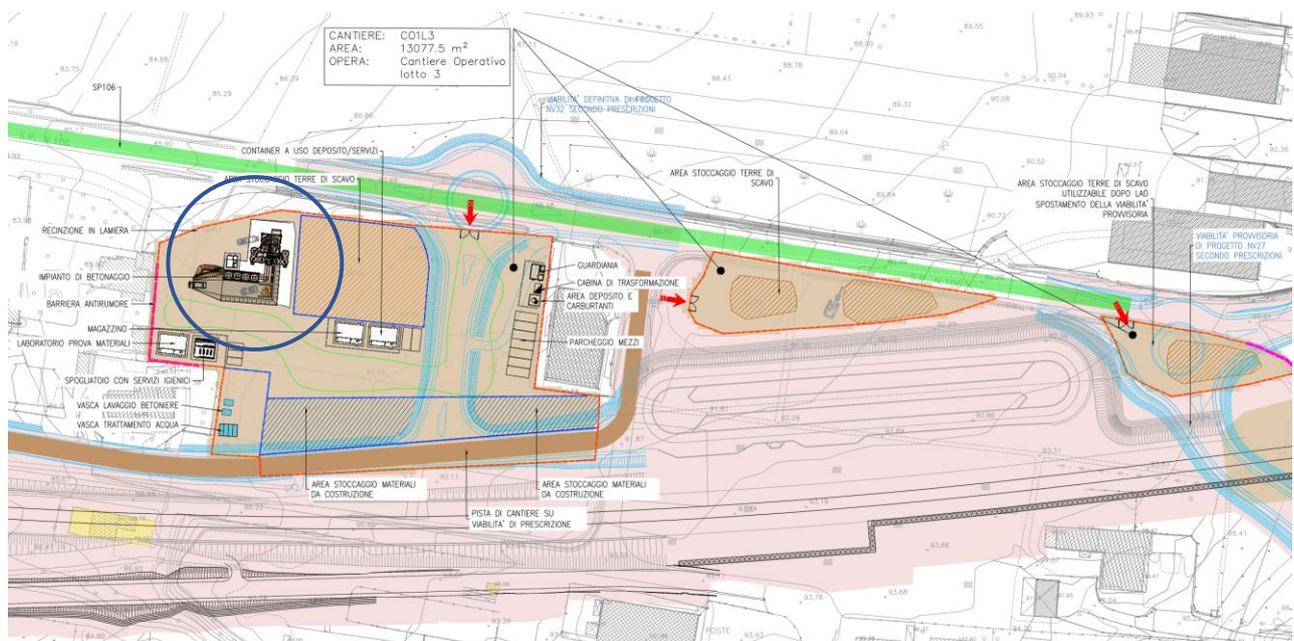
Planimetria area CO1L3 con indicazione impianto di betonaggio
